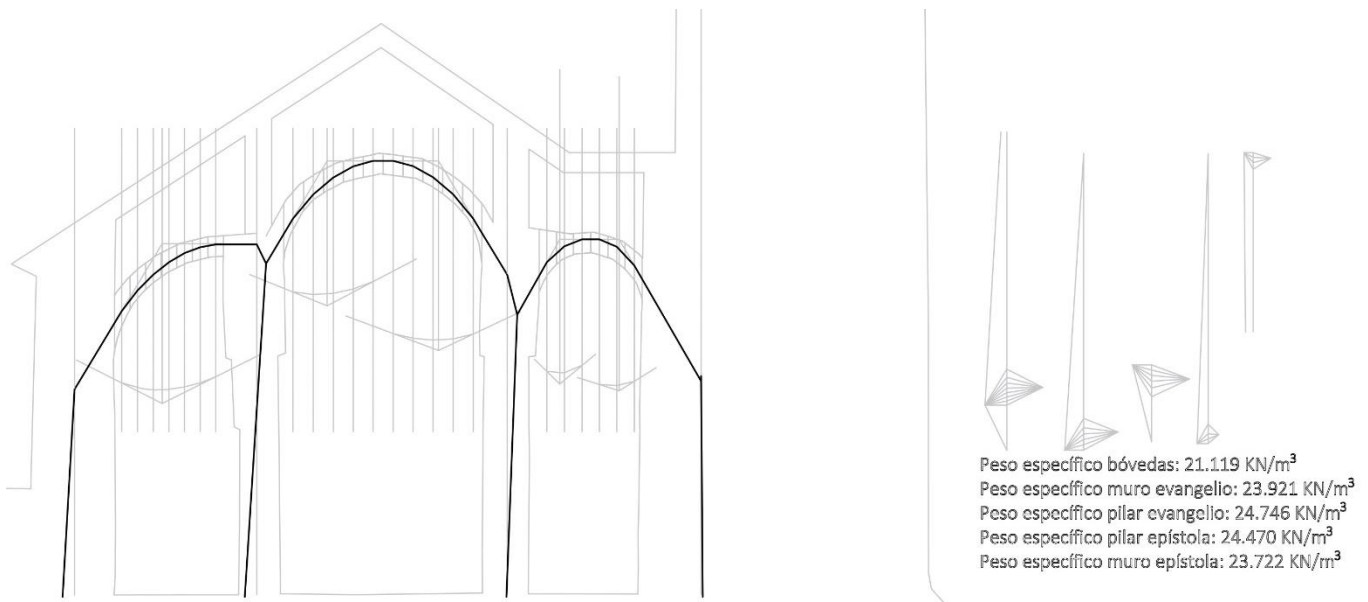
Estudio de la sección transversal por los pilares P3-P4 de Santa Maria de Vilamós.
